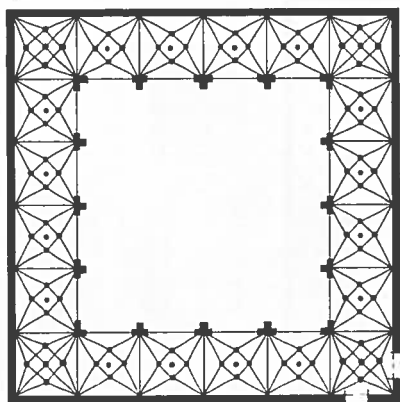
Planta del claustro del monasterio de S. Vicente de Oviedo
